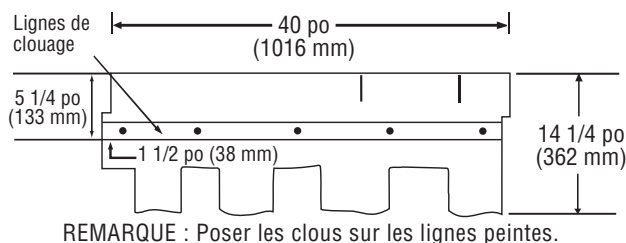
Fixation des bardeaux Presidential et Presidential TL sur les pentes faibles et standards.
